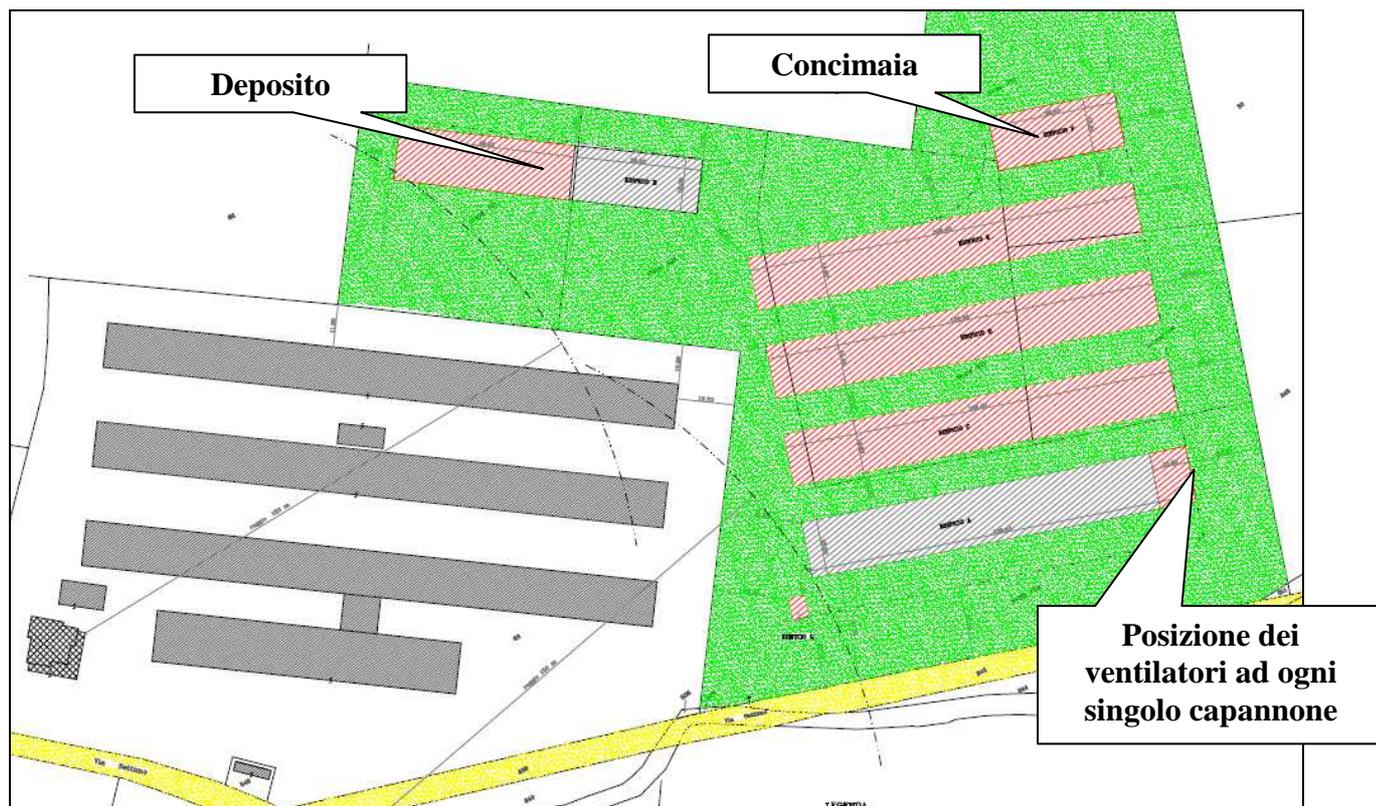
planimetria allo stato futuro segnalando in rosso gli stabilimenti di nuova costruzione
